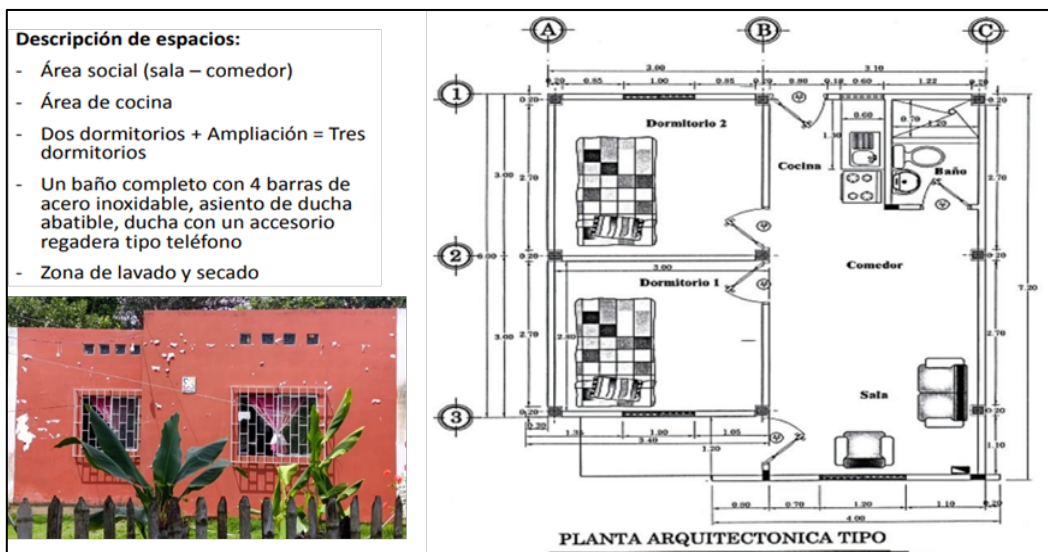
Características y plano arquitectónico de la VM del MIDUVI.
